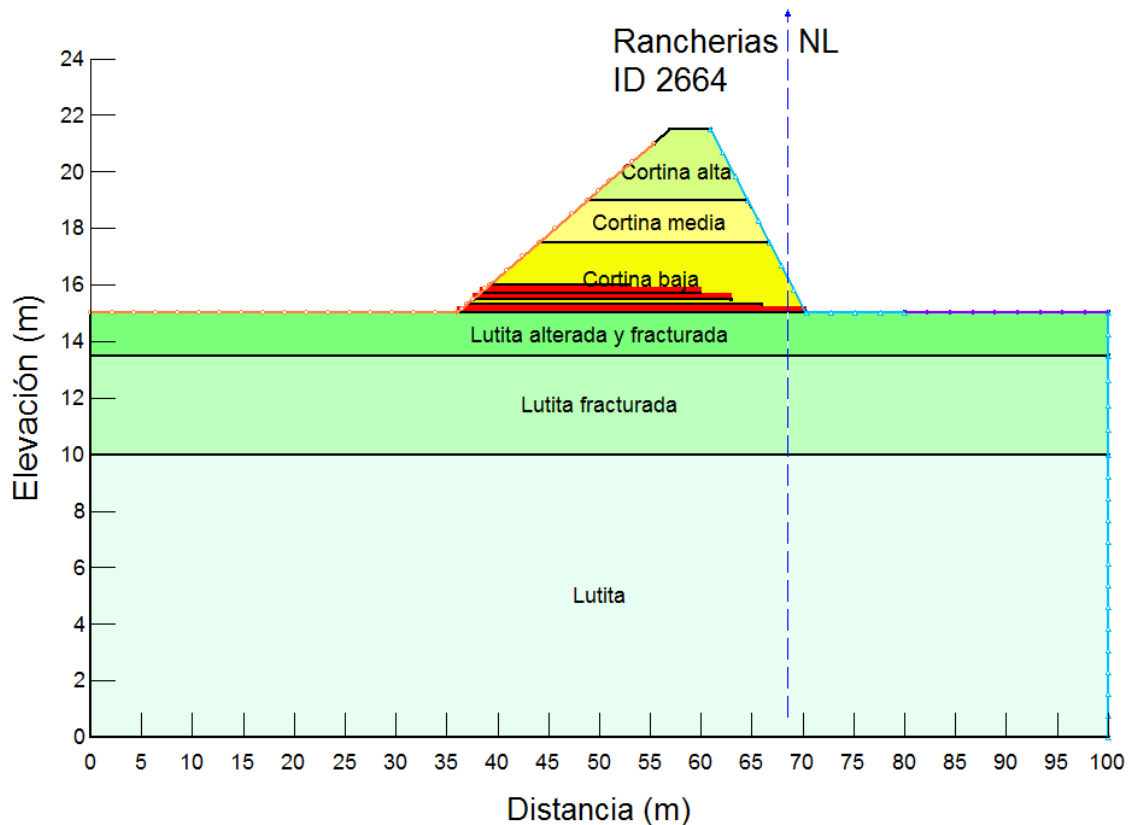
Modelo estratificado de la cortina y del subsuelo de cimentación.
